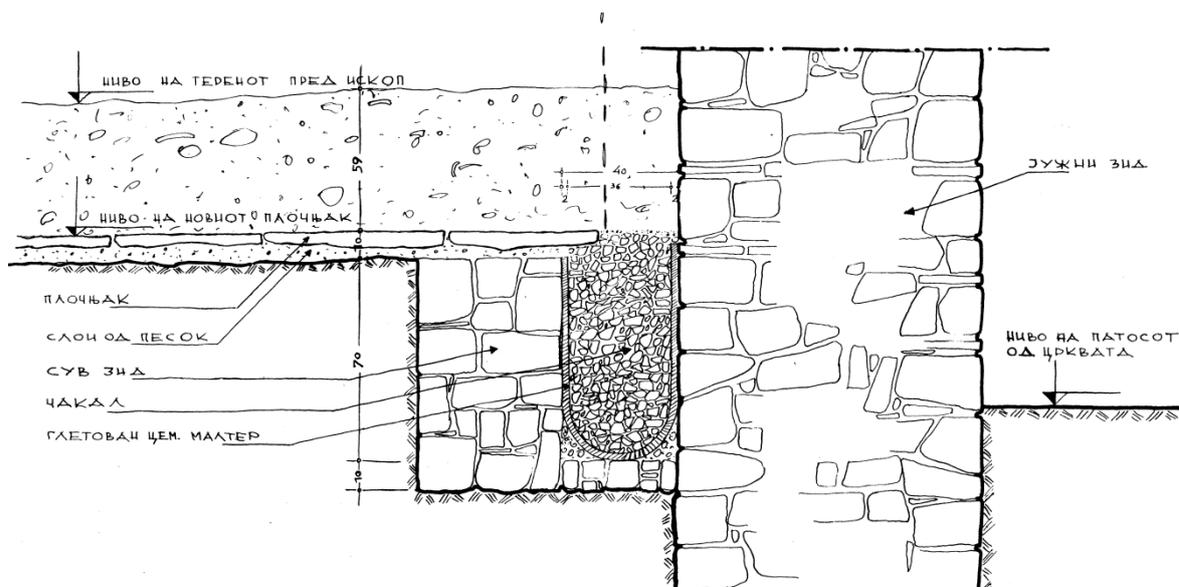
Proyecto para la elaboración de un sistema de canales de drenaje perimetrales.
